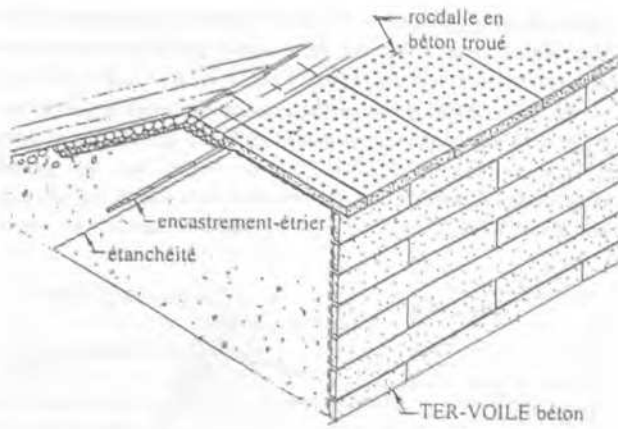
Seuil déversant, rocdalle béton troué-Coupe type
